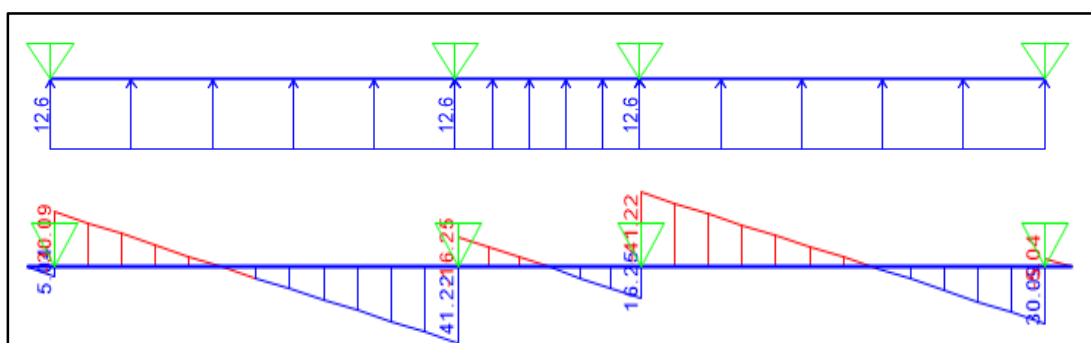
DFC de la losa – Losa de cimentación sin viga - Sistema dual tipo II
